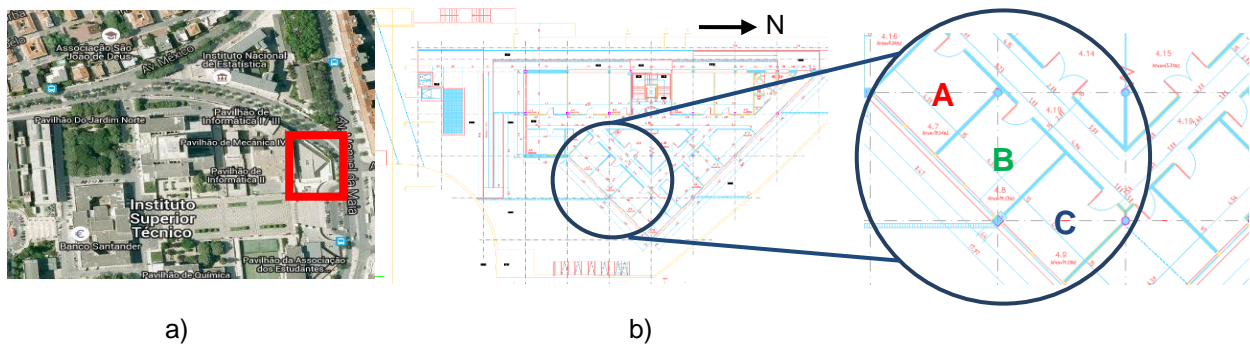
Localização do caso de estudo: a) localização do pavilhão dentro do IST; b) planta do pavilhão.
